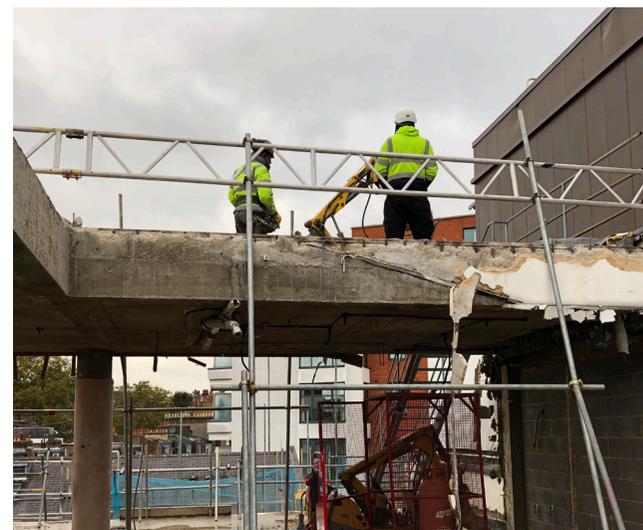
Demolizione del tetto per la costruzione del quinto piano.
